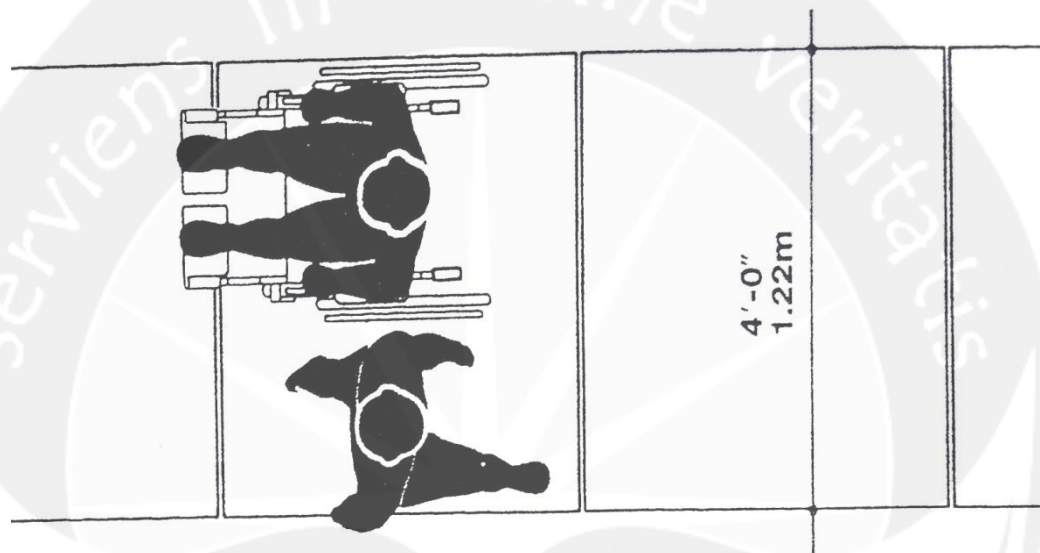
Ruang Parkir yang dapat Dilihat
